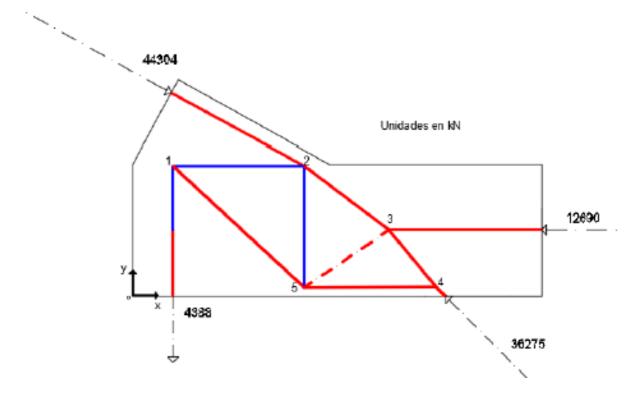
Modelo de Bielas y tirantes, vista en alzado (Fuente: Propia)
